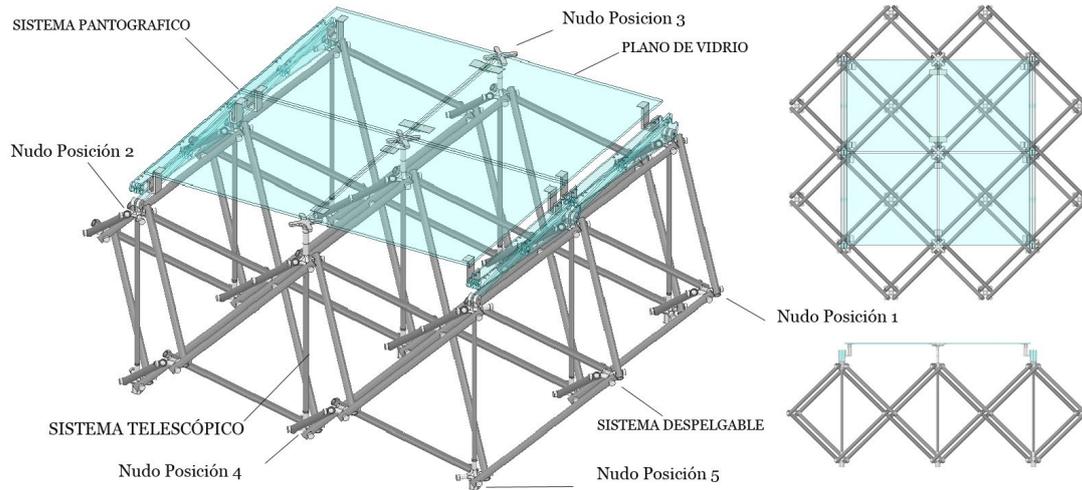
Axonometría, planta y alzado del Prototipo HG. Fuente: autores 2022
